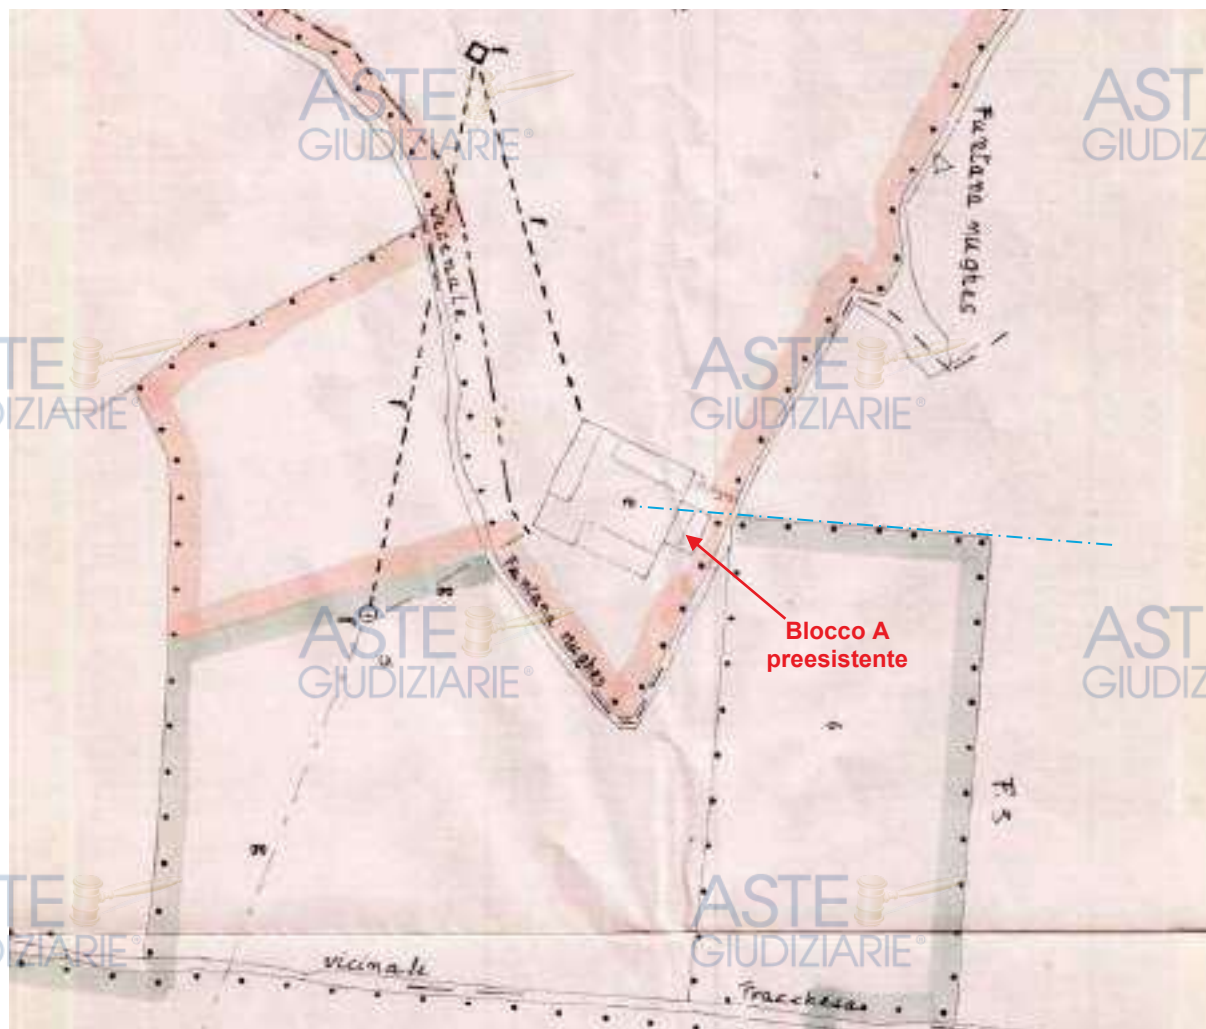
Stralcio del progetto approvato (C.E. 39/1990). Planimetria del lotto, fuori scala. Nord in alto
